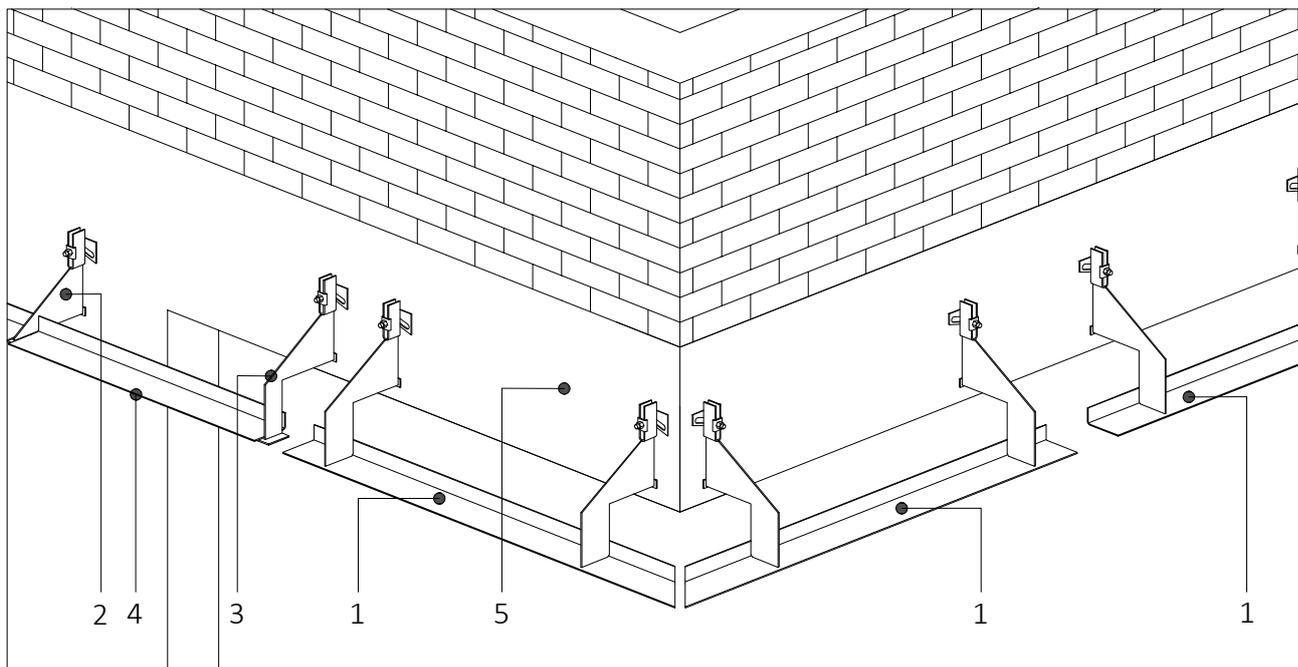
Вариант комплекта кронштейнов КСВ для крепления кирпичной облицовочной кладки над угловым проемом. 1 - кронштейн КСВ-FAR; 2 - кронштейн КСВ-N; 3- кронштейн КСВ-NA; 4 - промежуточный опорный уголок; 5 - ж. б. несущее основание.
